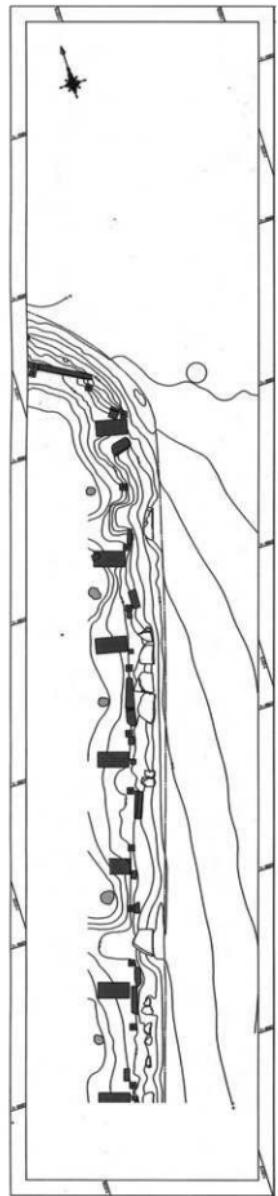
H25薄校弘道館跡構築調査 平面図・立面図・断面図 3
